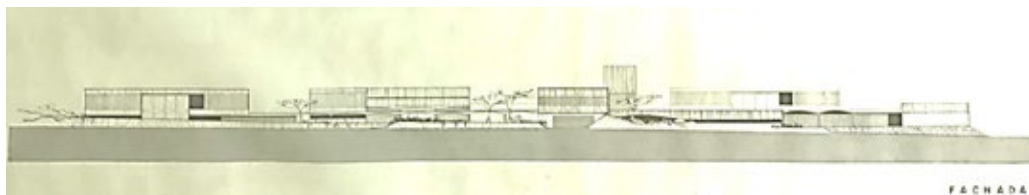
Fachada geral da UECE, primeira fase, Neudson Braga e Liberal de Castro (1976)
